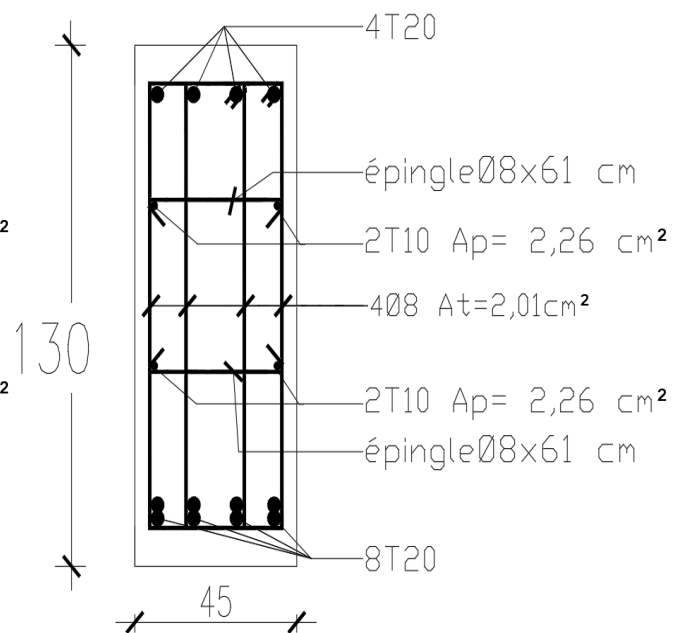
Schéma de ferrailage poutre secondaire.
